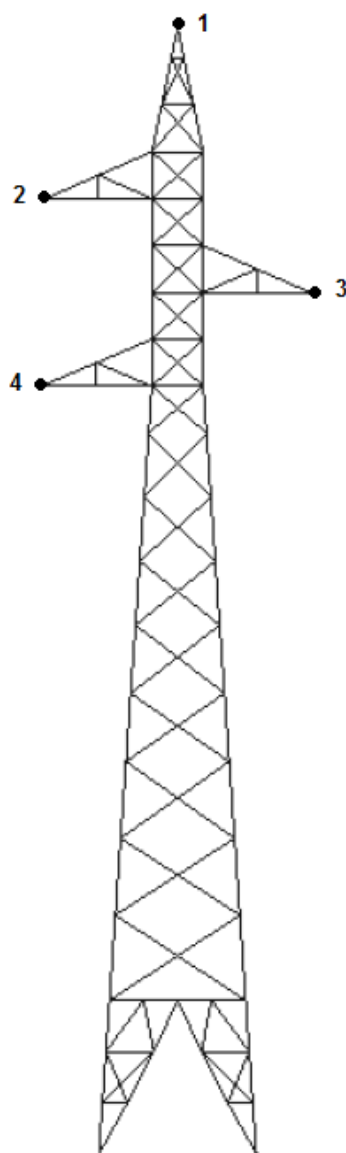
Torre de 132 kV: Sistema de cableado elegido.
